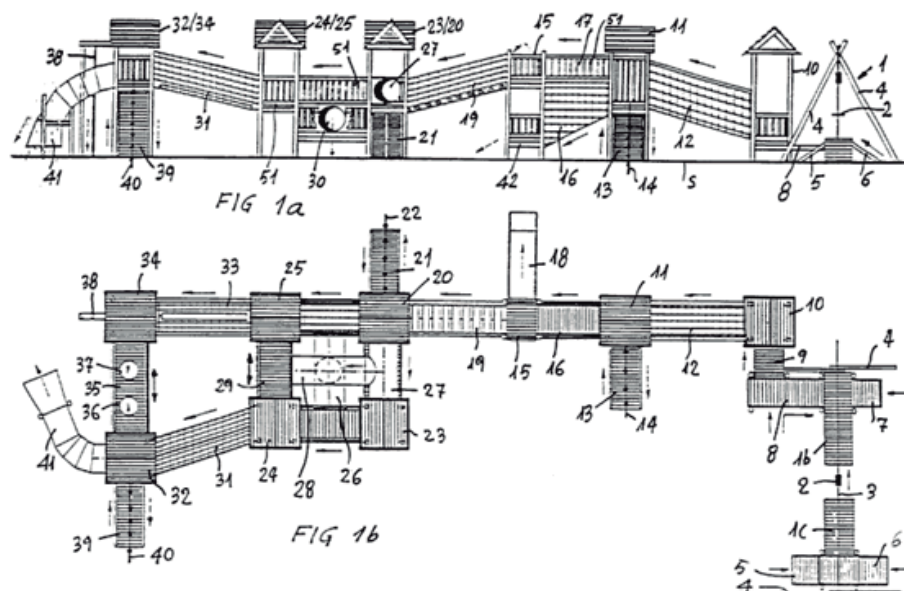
Parque infantil perfeccionado en alzado y planta. ES 1006858 U
